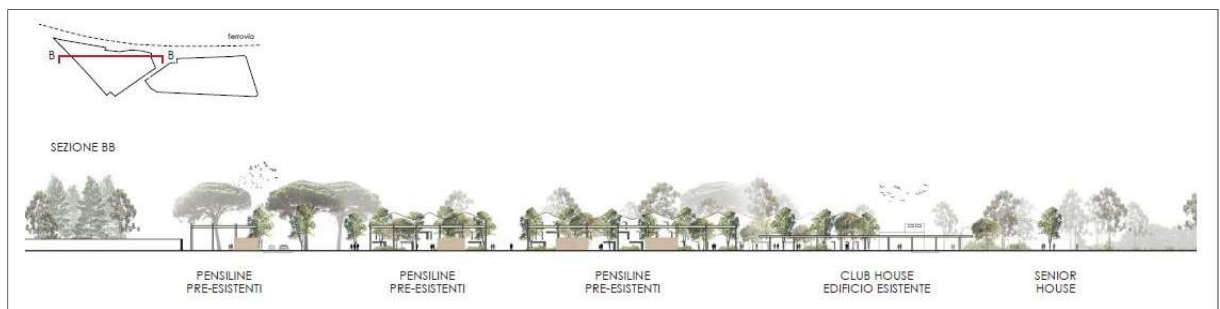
Localizzazione e vista esterna manufatti Area Nord.
